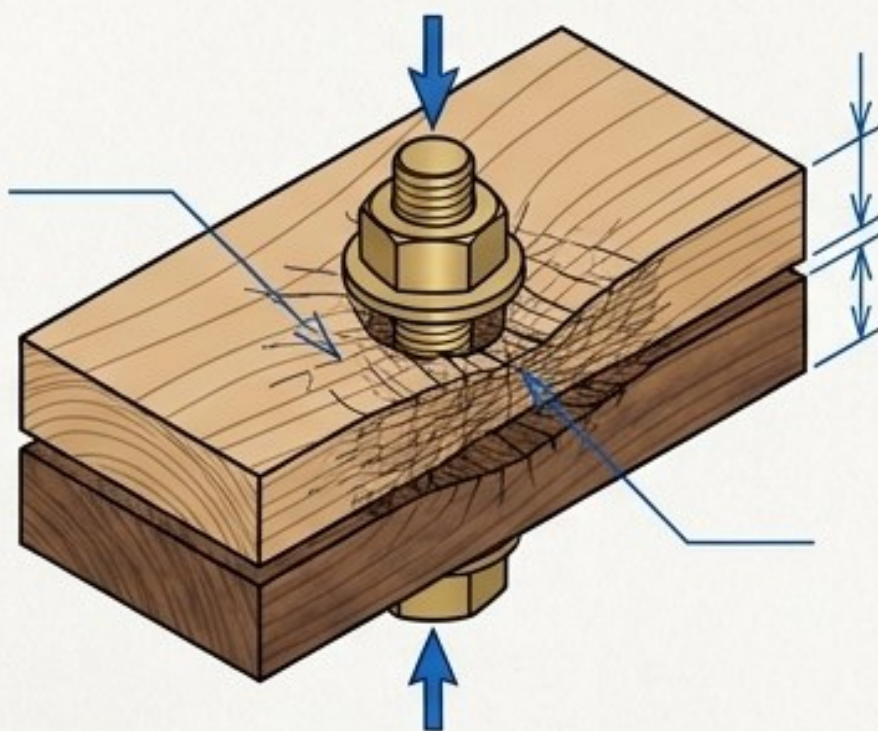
Geometría de las uniones con elementos de fijación de tipo clavija.
